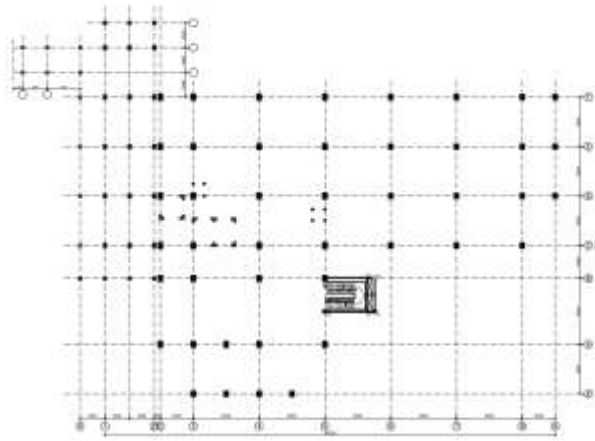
3 Denah lantai 1 gedung Covid-19
